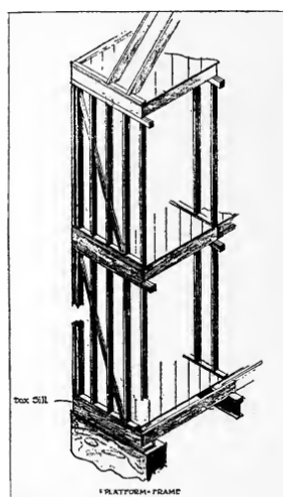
Sistema aligeirado Platform Framing / Western Framing
